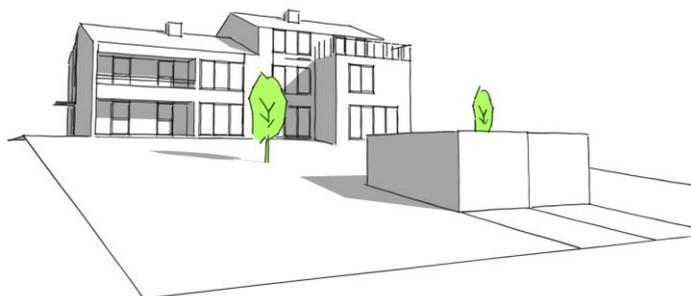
Erweiterungsmöglichkeit Haustyp 4 mit Dremfelerhöhung und Anbau, eigene Darstellung
